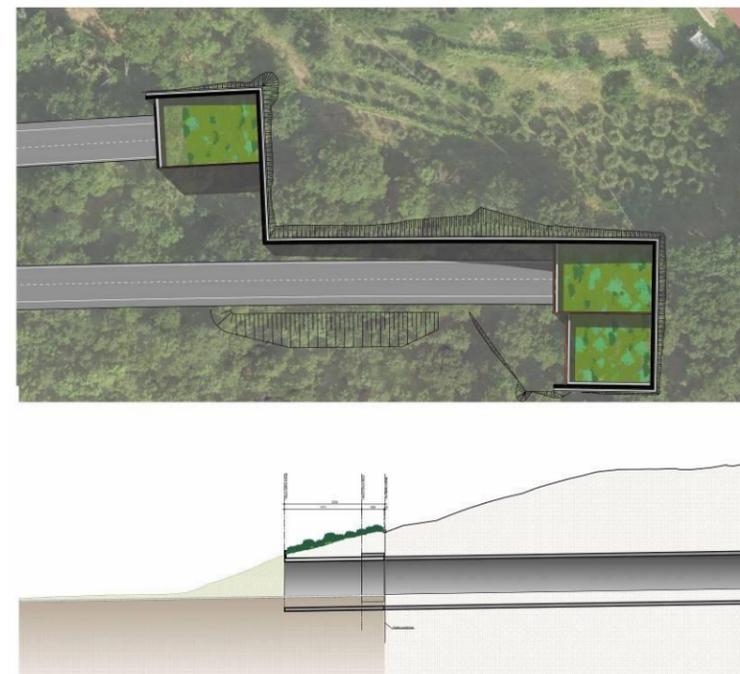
Planimetria e prospetto galleria Le Ville (imbocco ovest)
